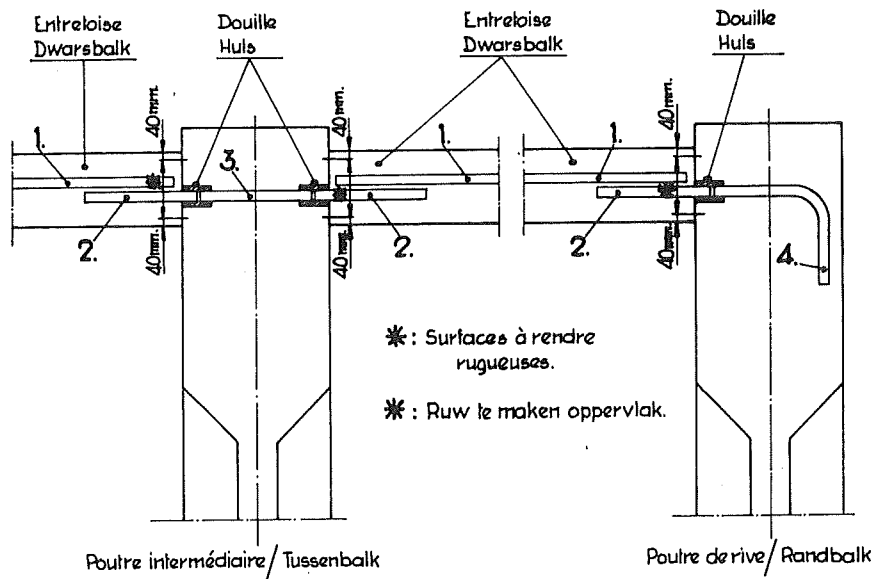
Liaison des poutres aux entretoises au droit des blocs d'about - Coupe horizontale.
